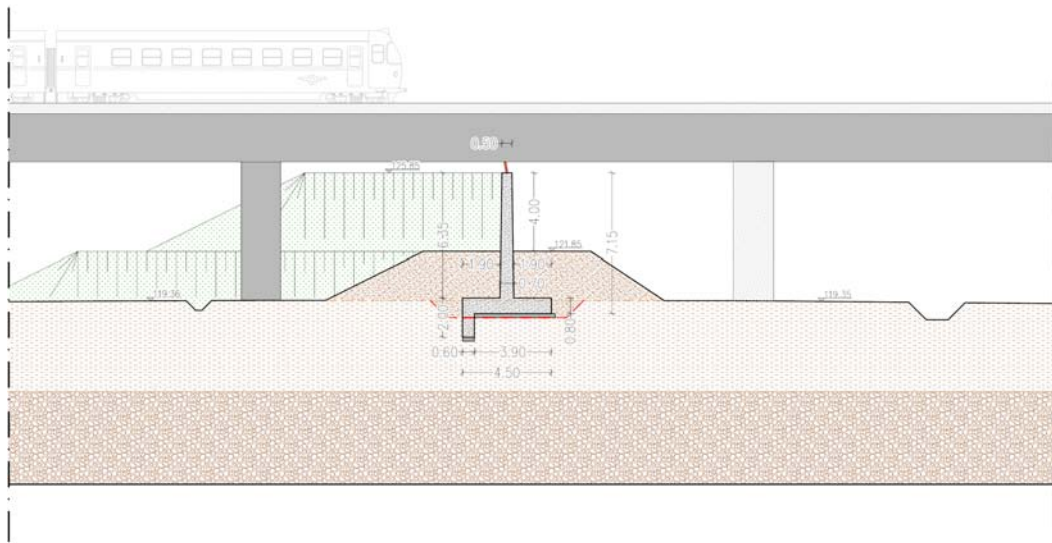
Sezione tipo muro d'argine sotto Viadotto Borratino
